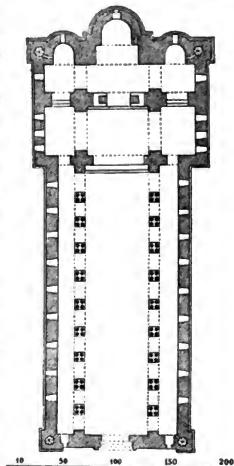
Ursprünglicher Grundriß des Domes zu Palermo.
